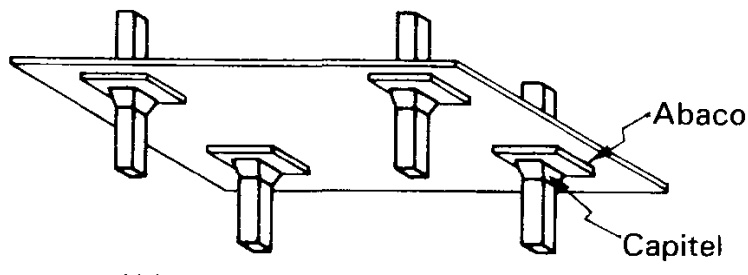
Modalidades de la losa plana de concreto reforzado.
